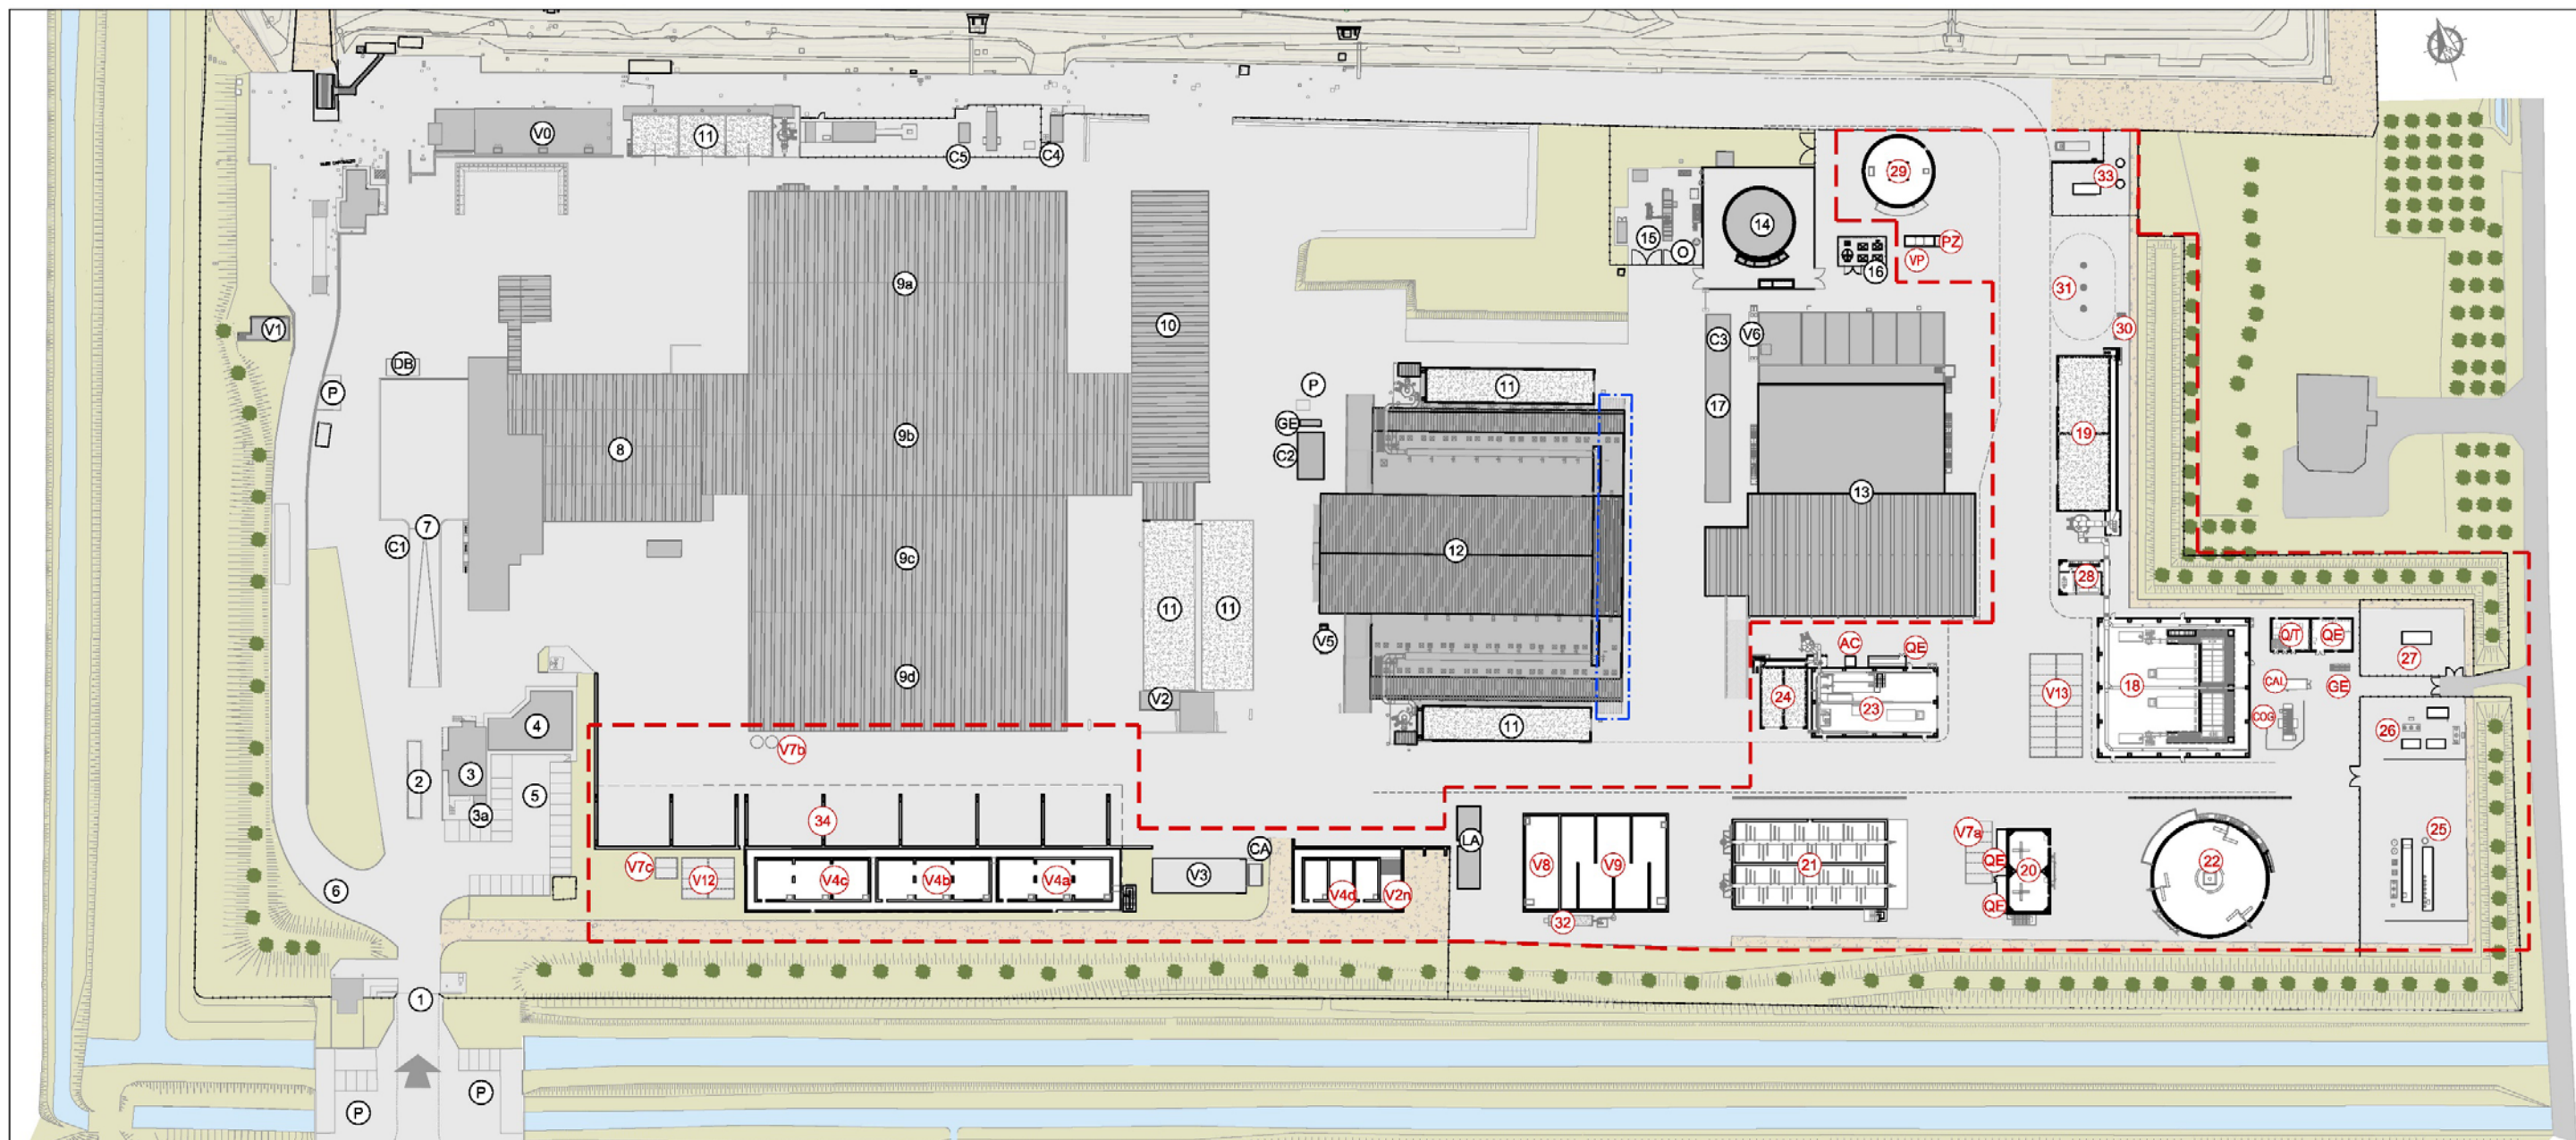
Estratto tavola ARC_002 - Planimetria con indicazione delle principali sezioni impiantistiche di progetto
